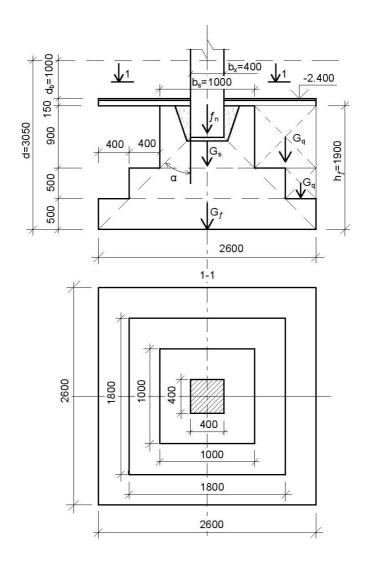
Схема монолитного железобетонного столбчатого жесткого фундамента стаканного типа
